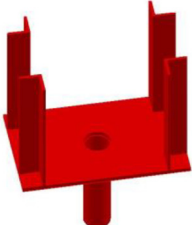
Втулочное соединение лесов опалубки на объемных стойках
